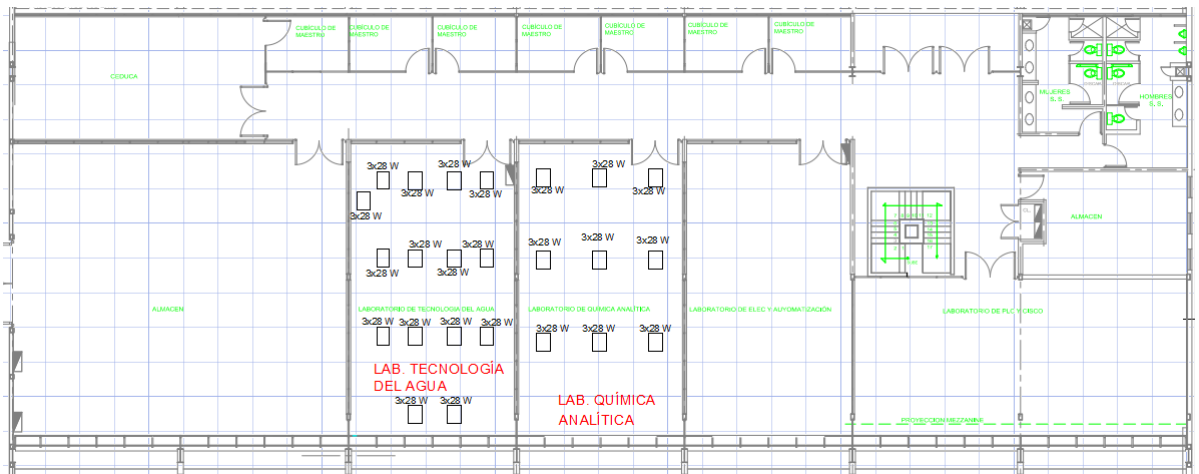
Distribución de las áreas de trabajo y cantidad de luminarias y lámparas en la planta baja del taller T1. Fuente: Elaboración propia.
